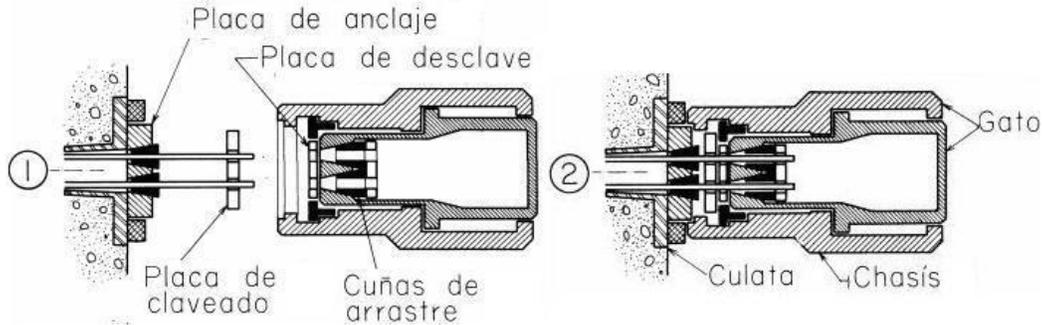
Gato empleado para el presfuerzo, sistema Stronghold.
